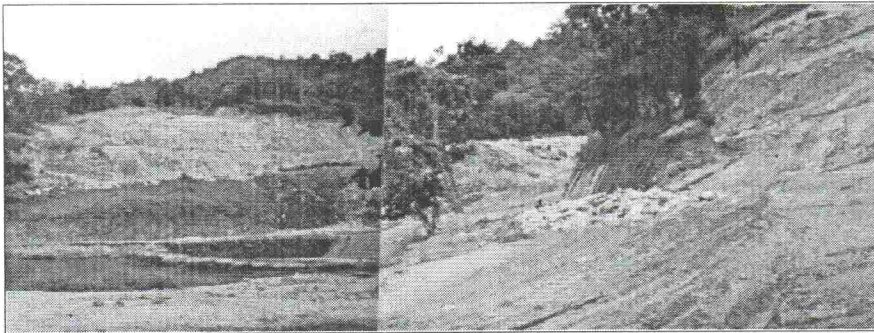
Vista parcial do Aterro Sanitário e Lagoa de Decantação.
